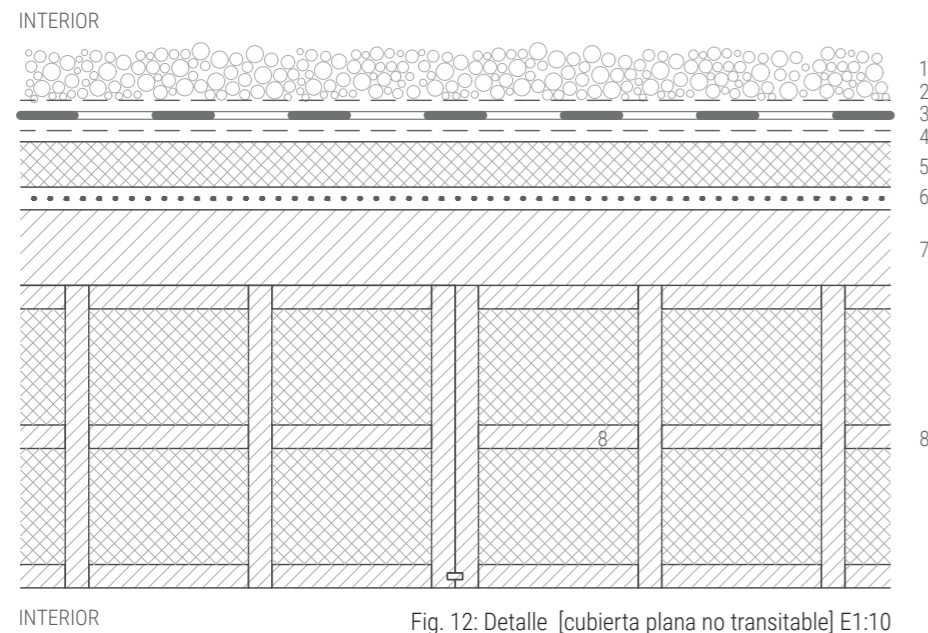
Detalle [cubierta plana no transitable] E1:10
